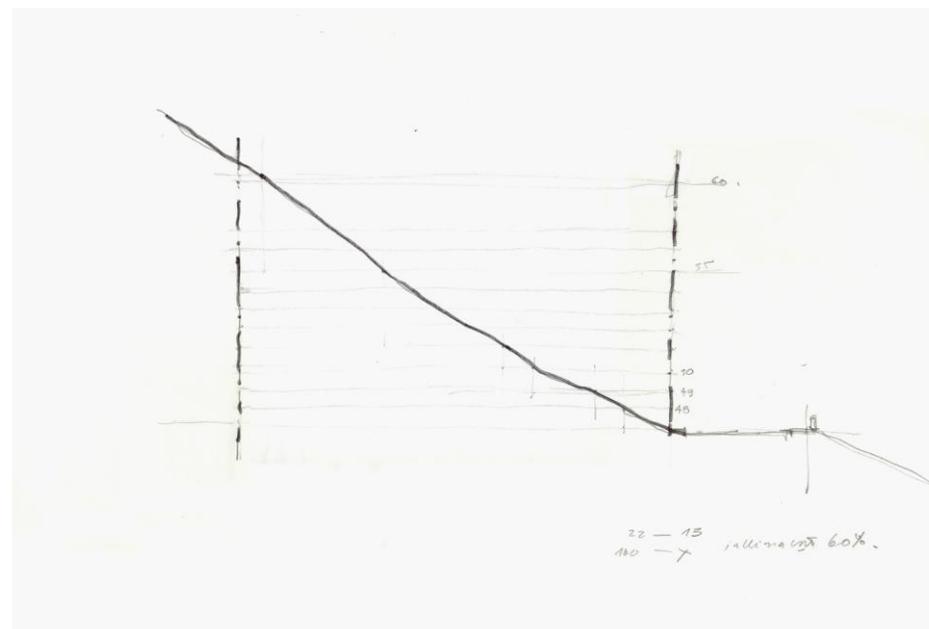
Primeiro desenho realizado pelo arquiteto. Corte na escala 1:100.
